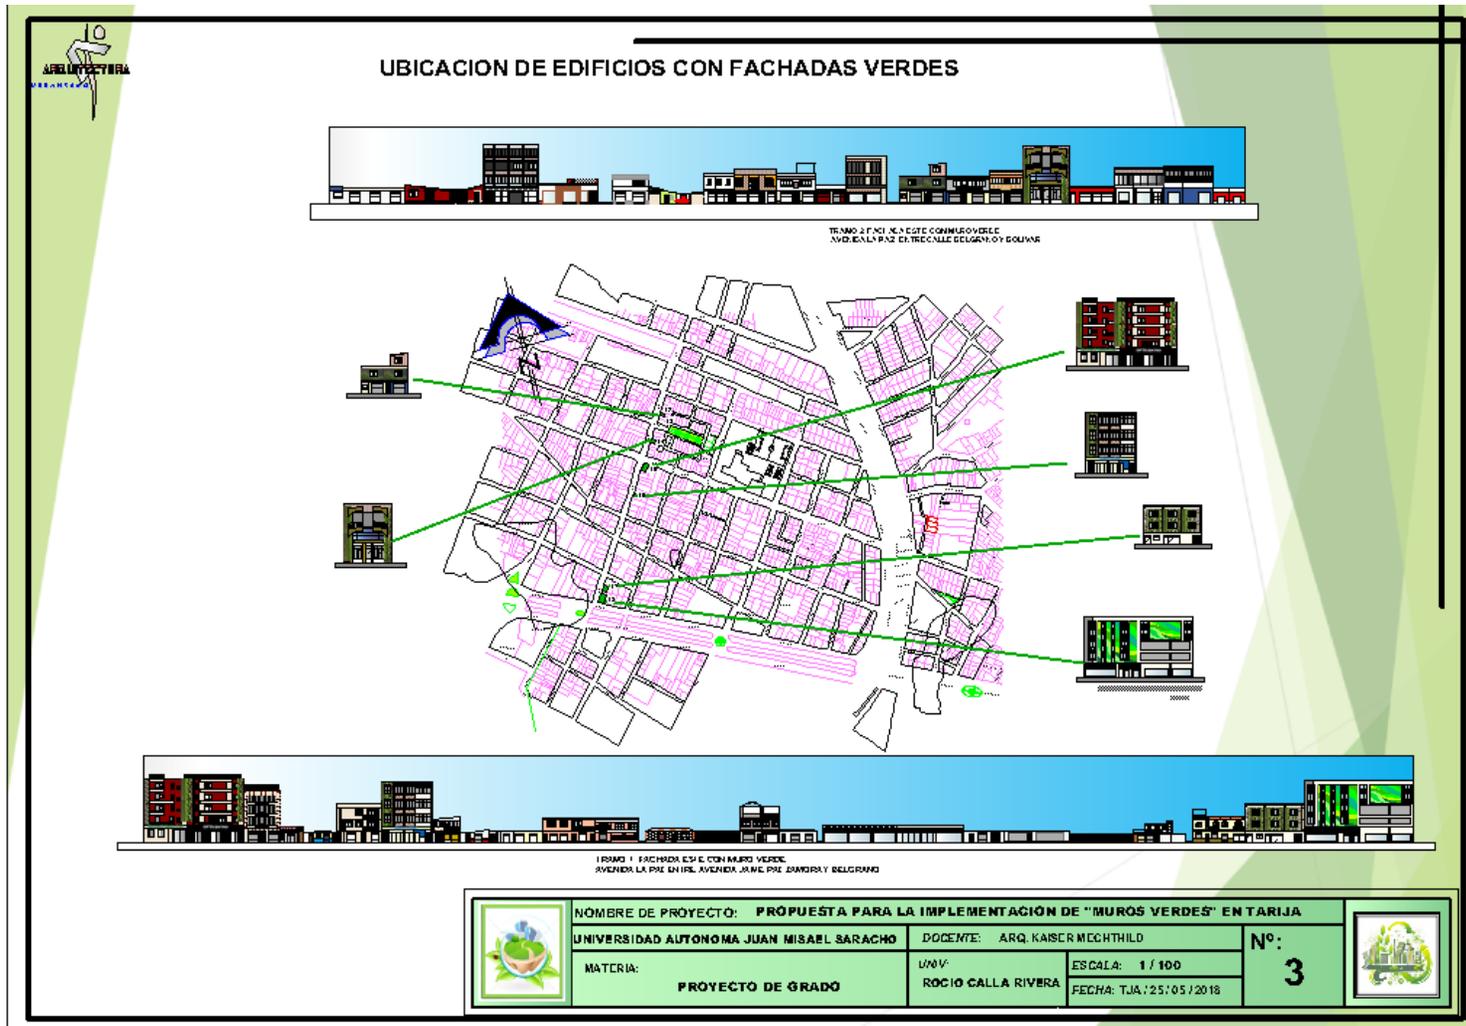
Plano con ubicación de muros verdes fachada este
